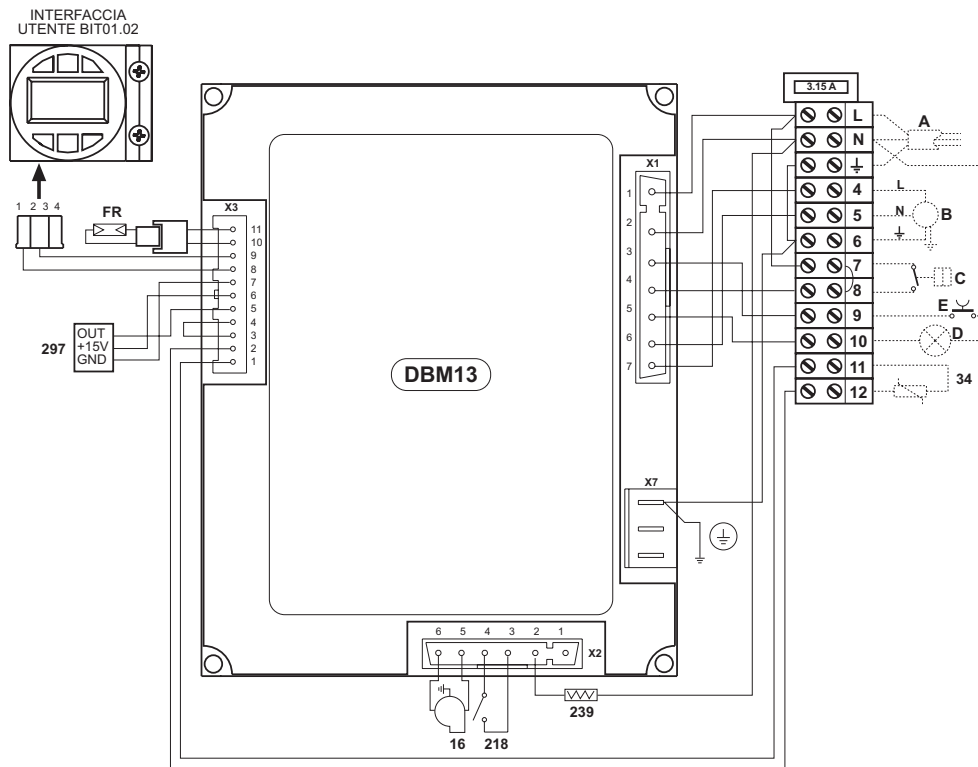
Schemă electrică cu panou de borne cu 12 poli
